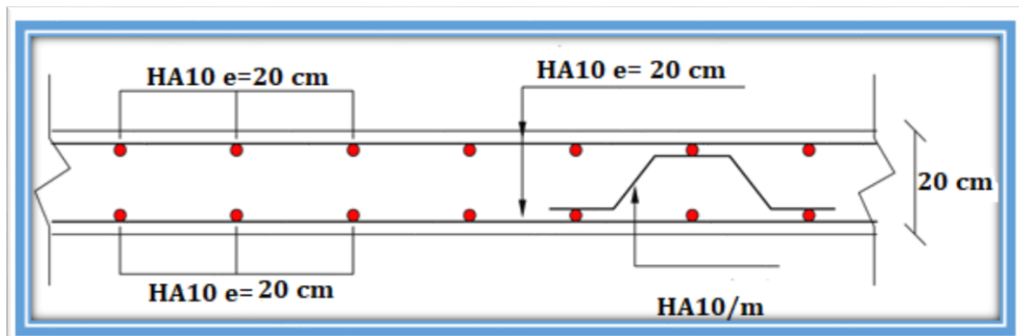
Schéma de ferrailage de la dalle machine d'ascenseur.
